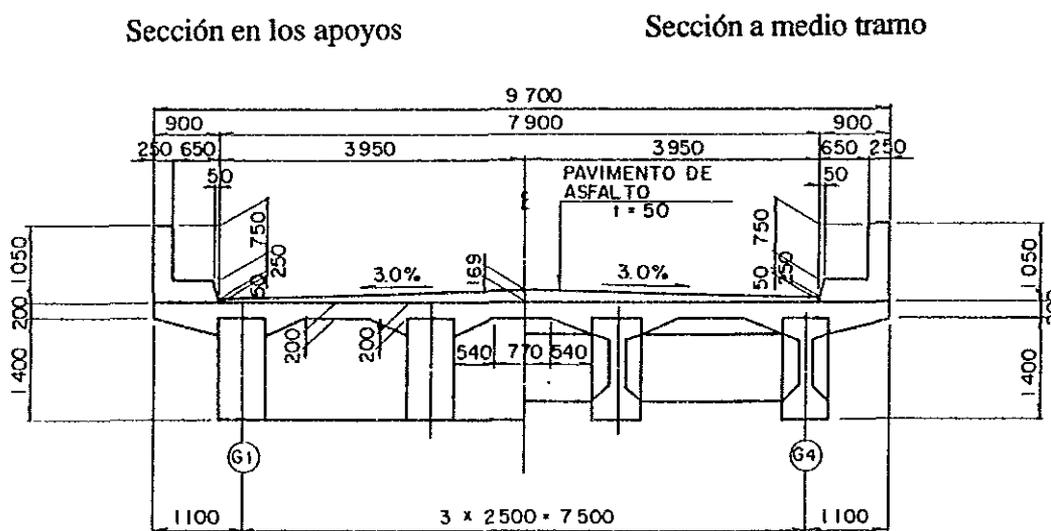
Sección de las vigas compuestas simplemente apoyadas de concreto postensado
